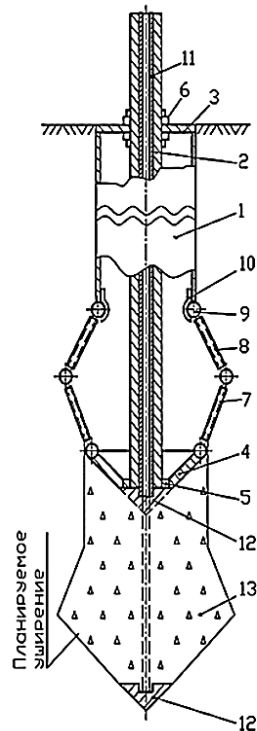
Схема анкерной сваи с уширителем: 1 — обсадная труба; 2 — полый металлический сердечник; 3 — верхняя пластина; 4 — нижняя пластина; 5 — проставка; 6 — муфта; 7 — сегменты; 8 — ролики; 9 — шарниры; 10 — кожух шарнира 9; 11 — арматура; 12 — заглушка полого сердечника; 13 — бетонная смесь
